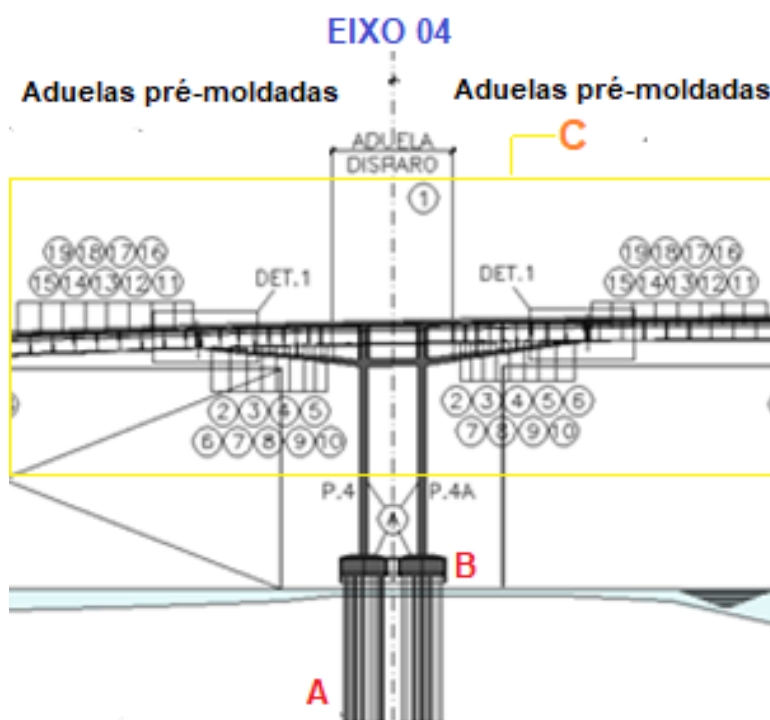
Planta estrutural dos balanços sucessivos sobre o Guaíba – sequência construtiva
